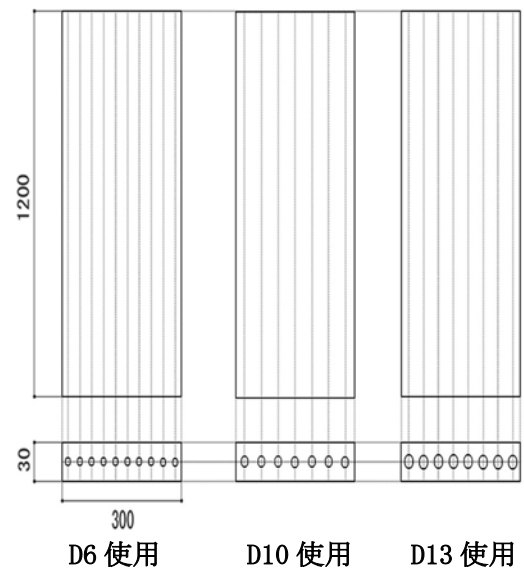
ひび割れ発生試験用供試体の形状 (mm)
